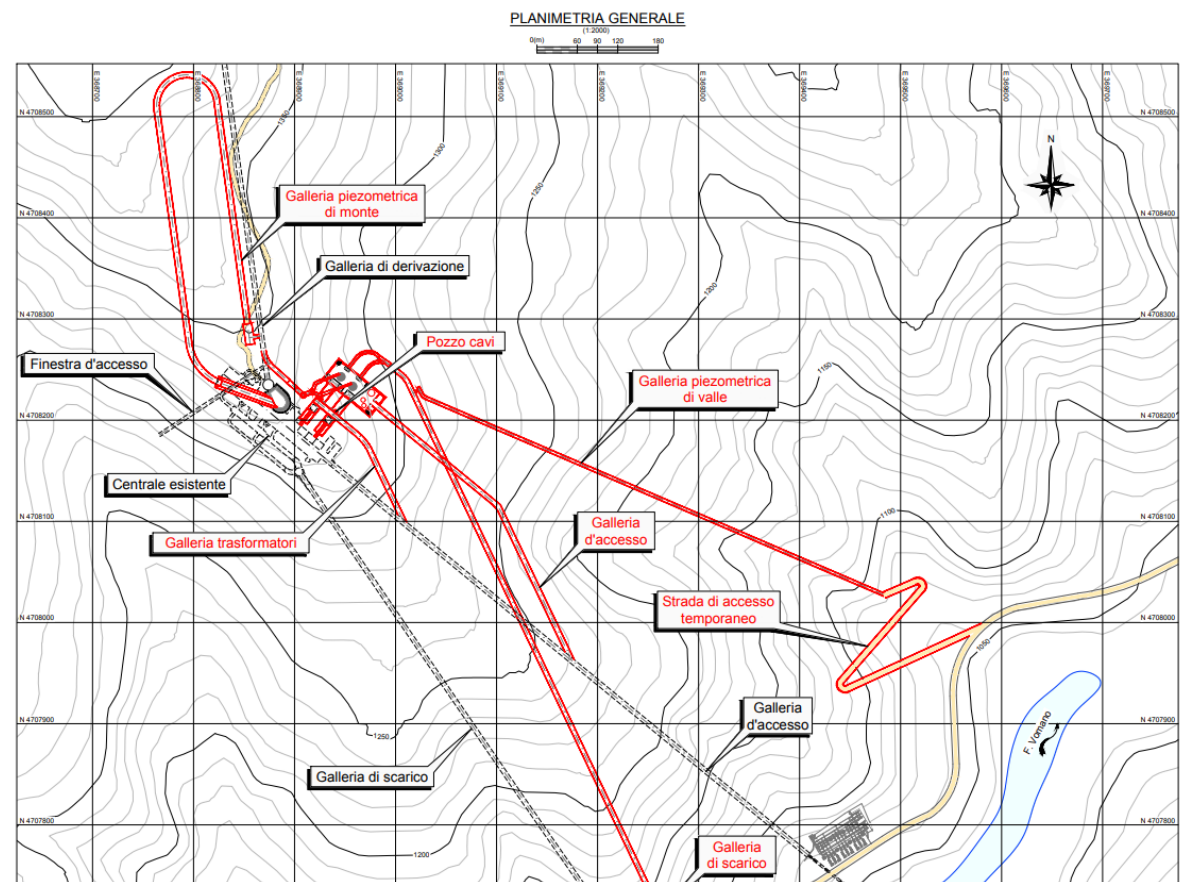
Impianto di Provvidenza – Stato di progetto – planimetria generale
